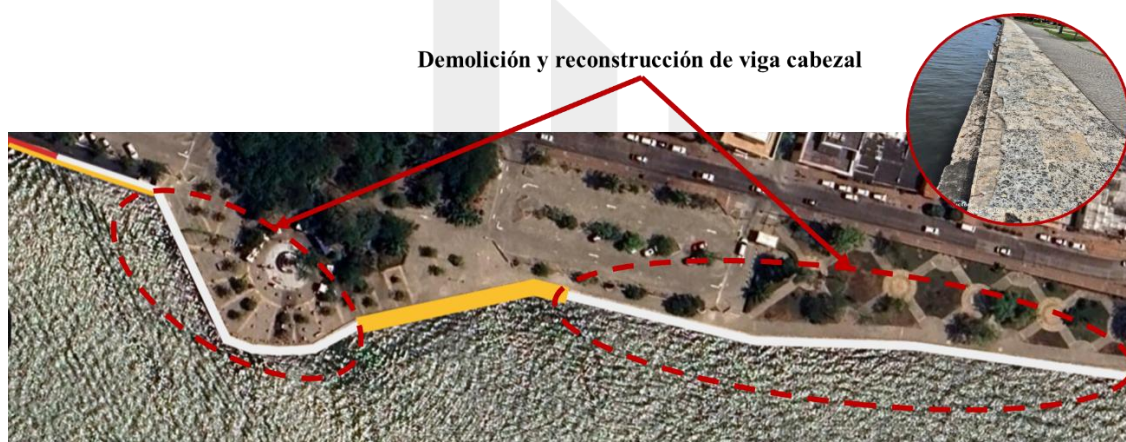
Ubicación de intervenciones de demolición y reconstrucción de viga cabezal en sector 6
